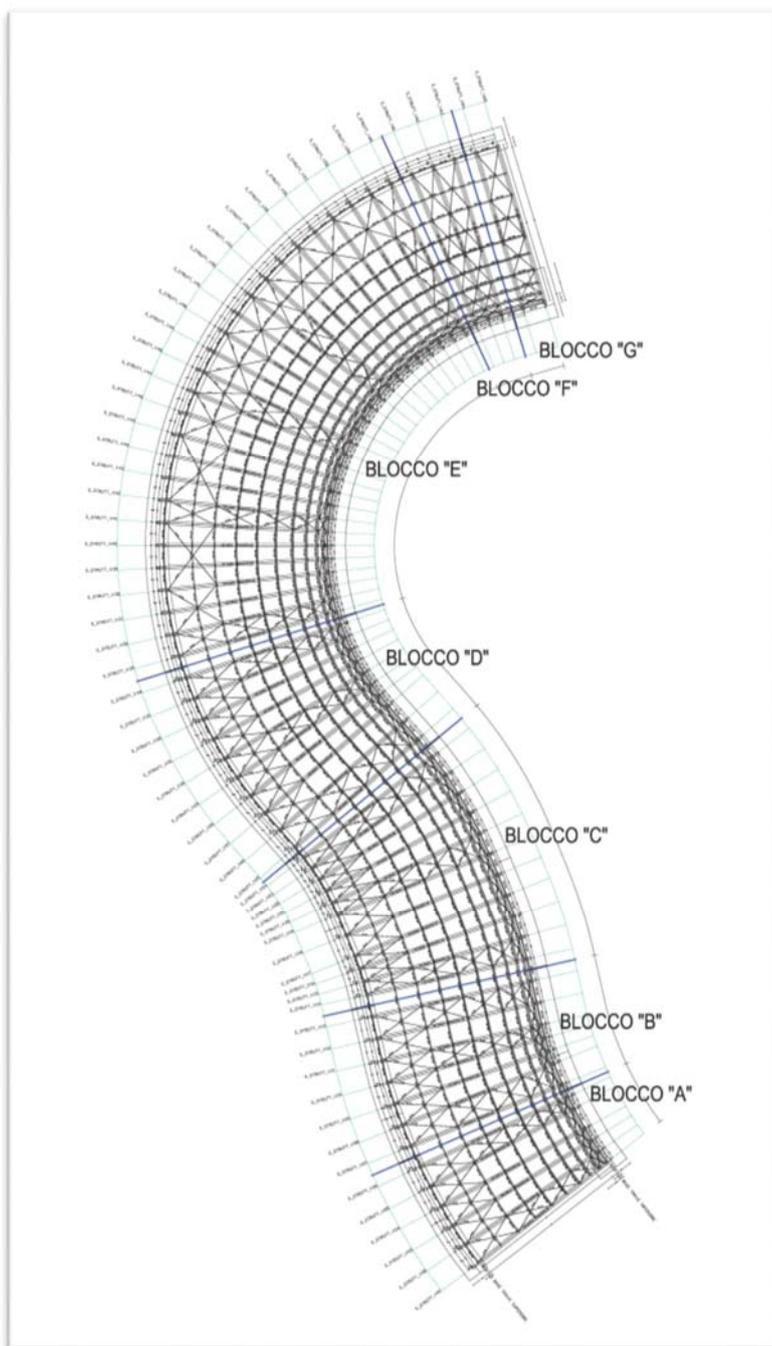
(Pianta con individuazione dei blocchi della struttura: Blocco A – B – C- D- E- F- G)
